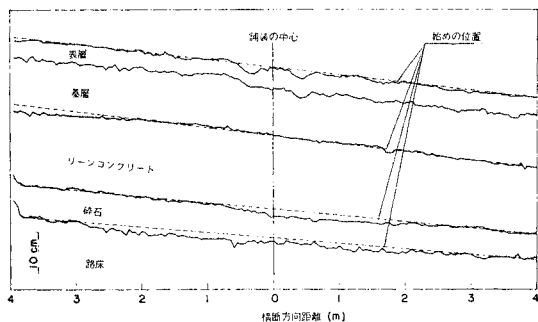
No. 15-1 (LC-1) 舗装の解体断面図
